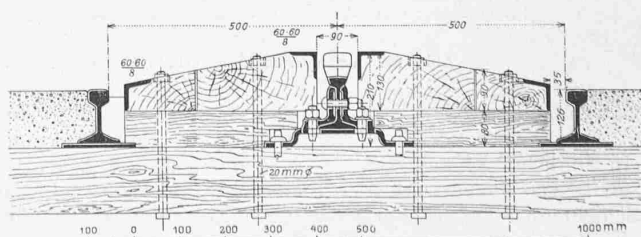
Niveauübergang der Zahnstangenstrecke. — 1 : 15.
